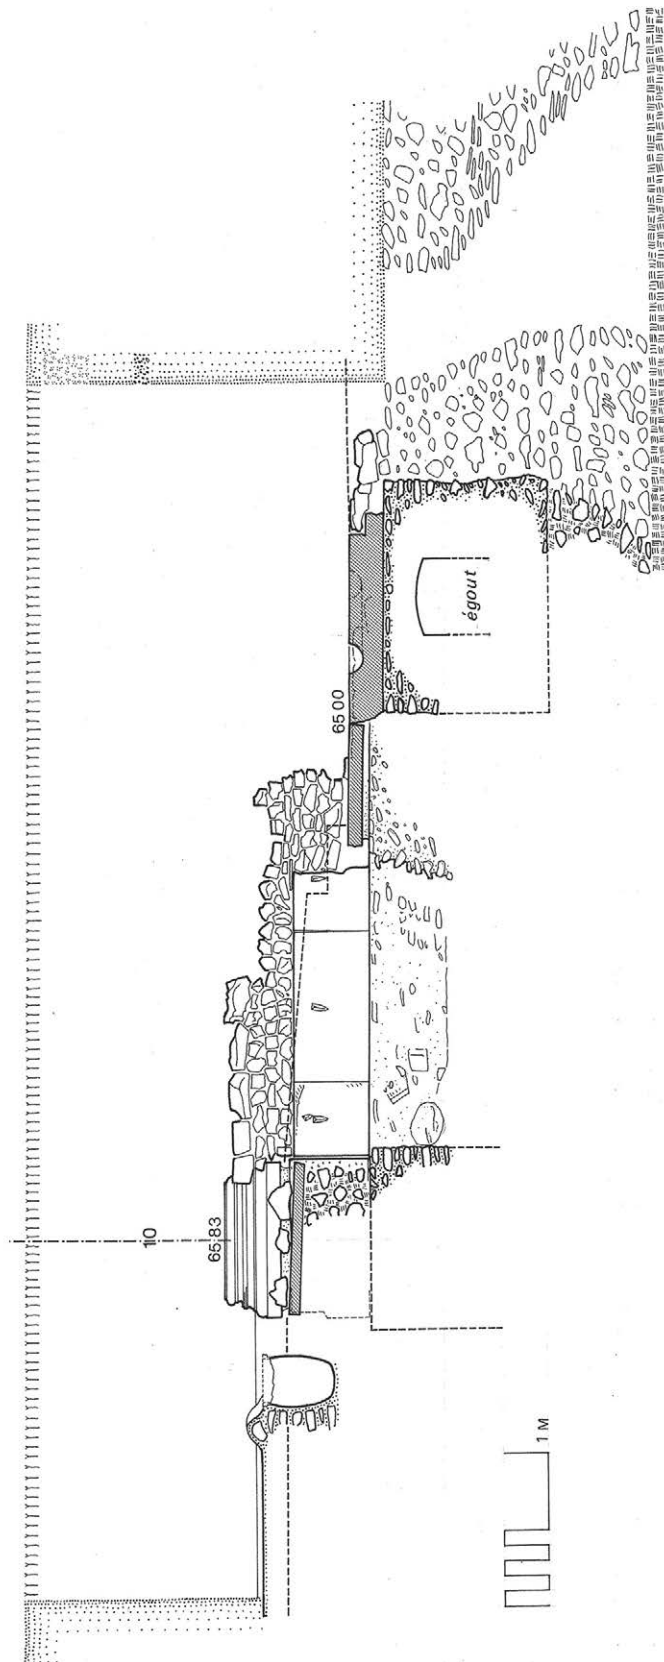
Coupe transversale à l'est du perron sud (G. Hallier).
